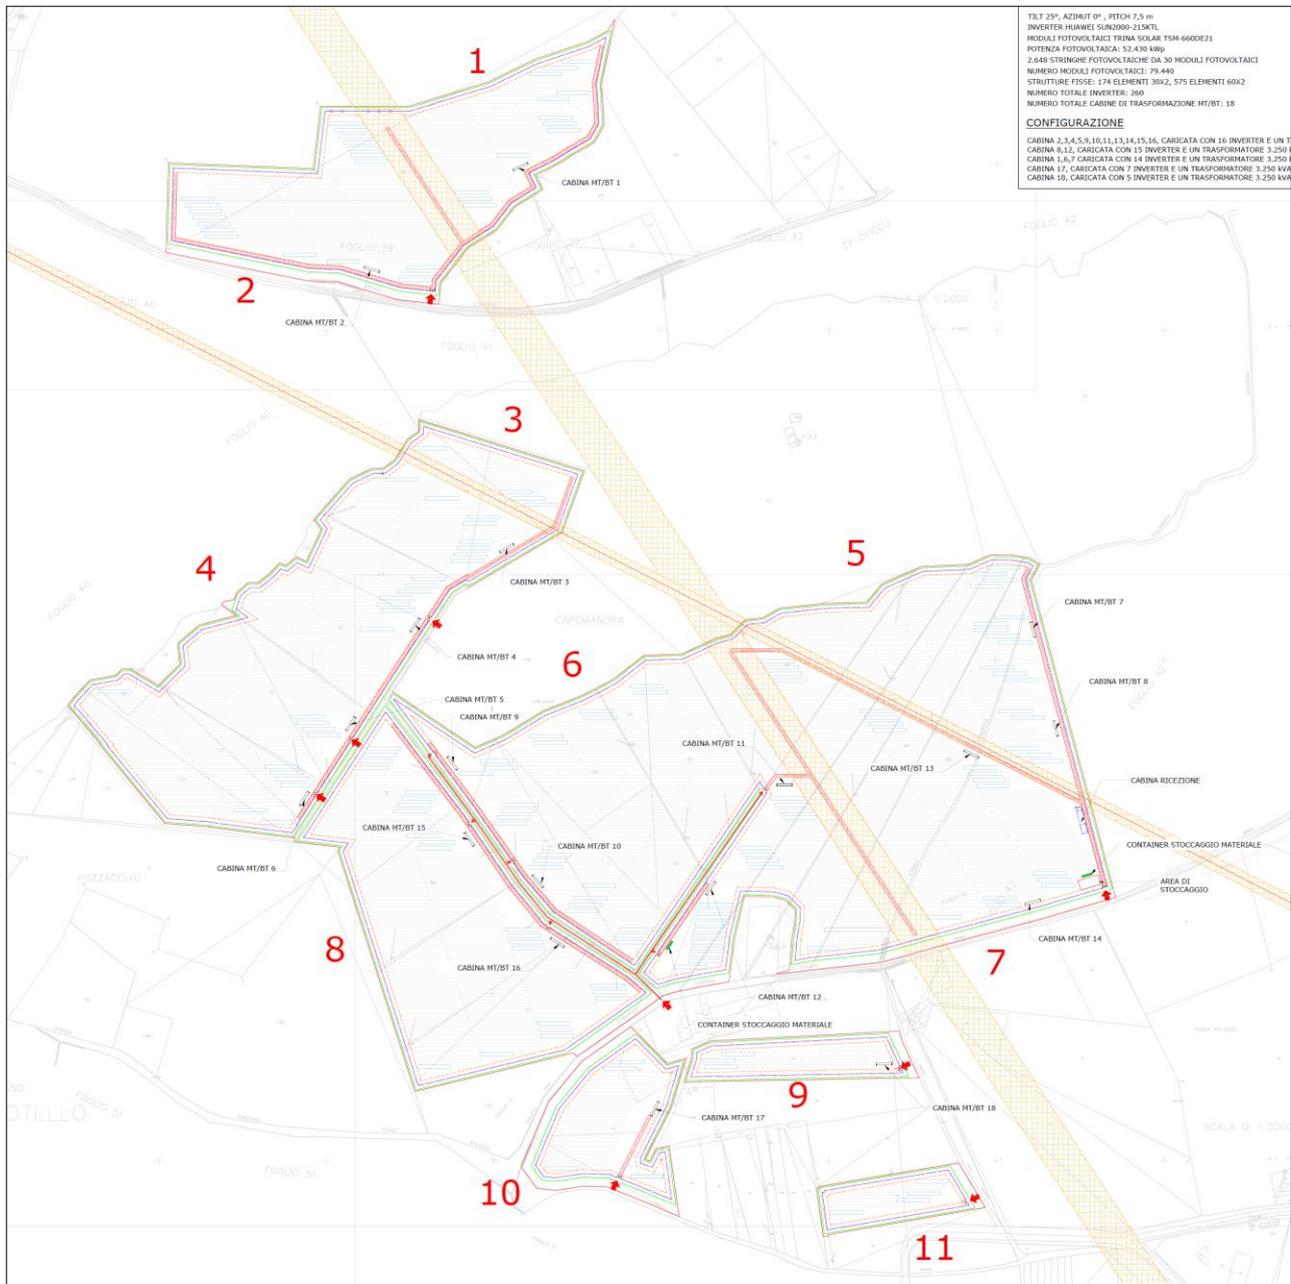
il layout di Rotello 52.4 (fuori scala). La planimetria ben visibile è negli elaborati di progetto.
